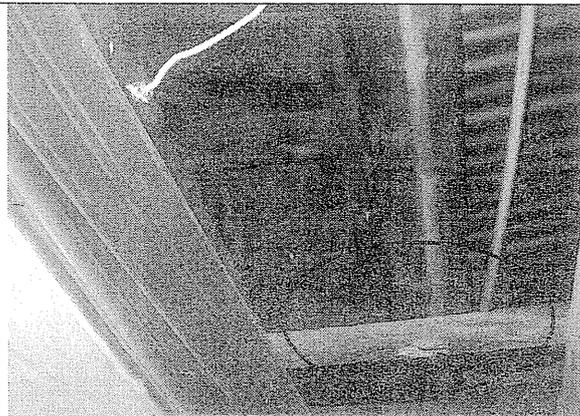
Elementos de madera de la cubierta en malas condiciones.
